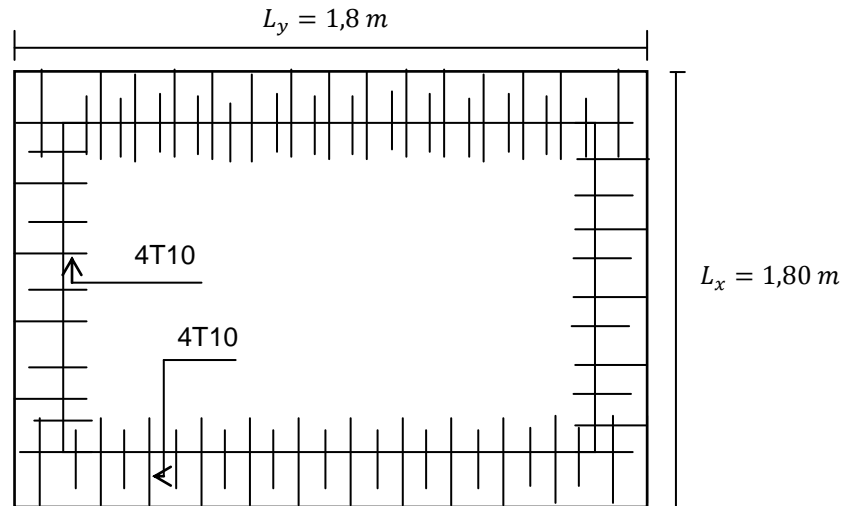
Ferrailage Supérieur de la dalle de l'ascenseur
